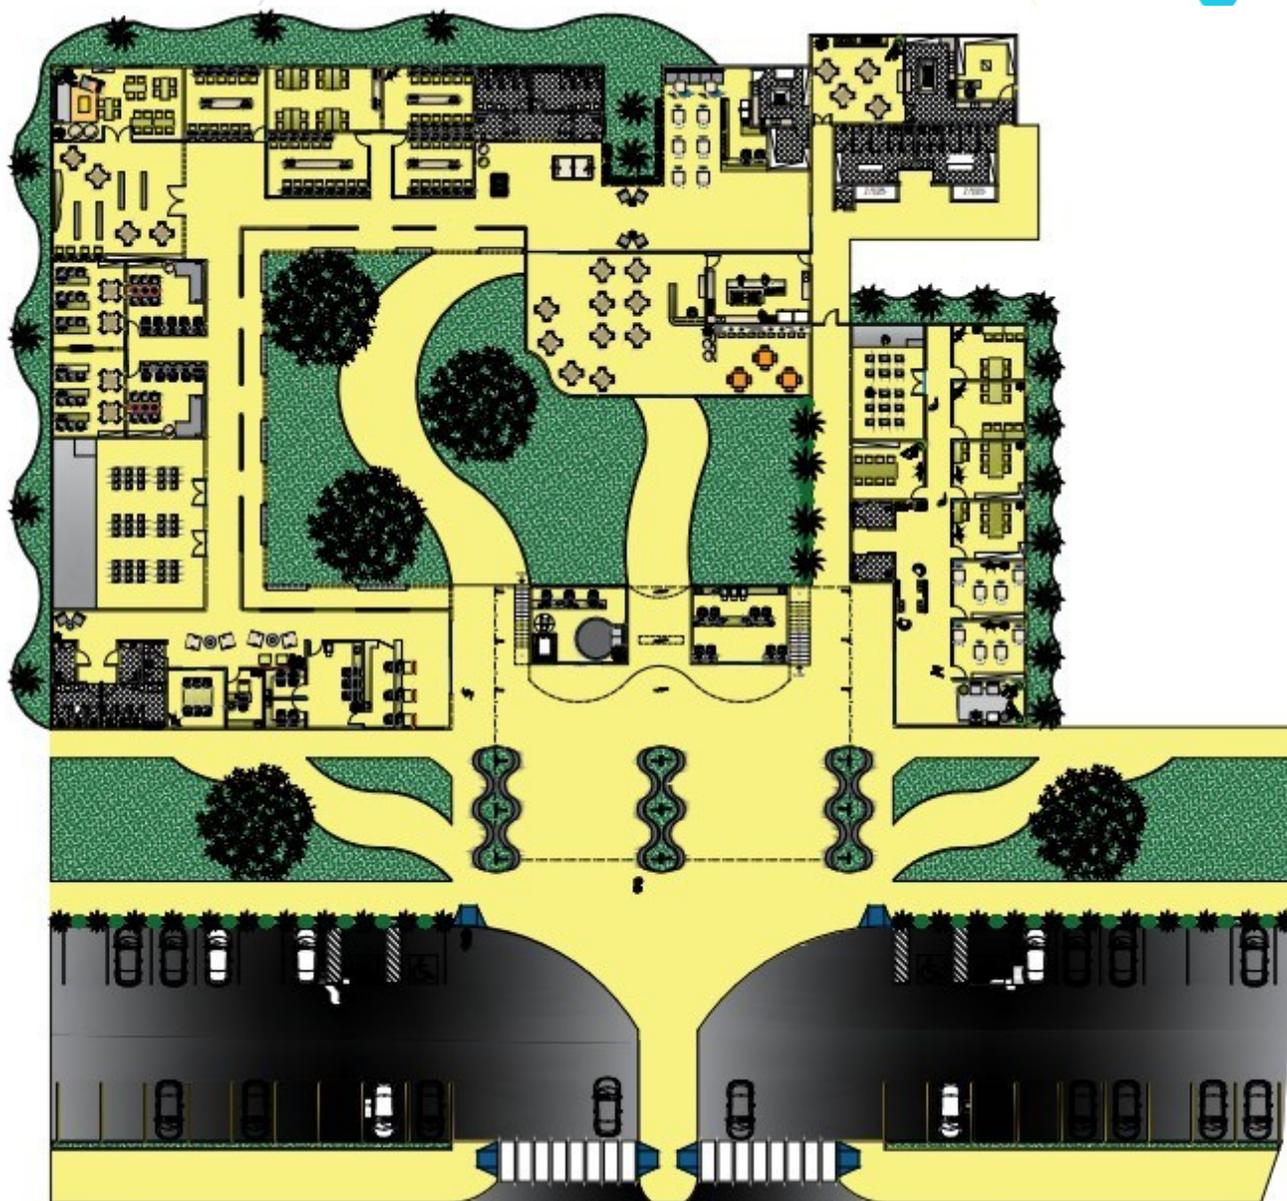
Planta de Layout. Fonte: pelo autor (2023).
